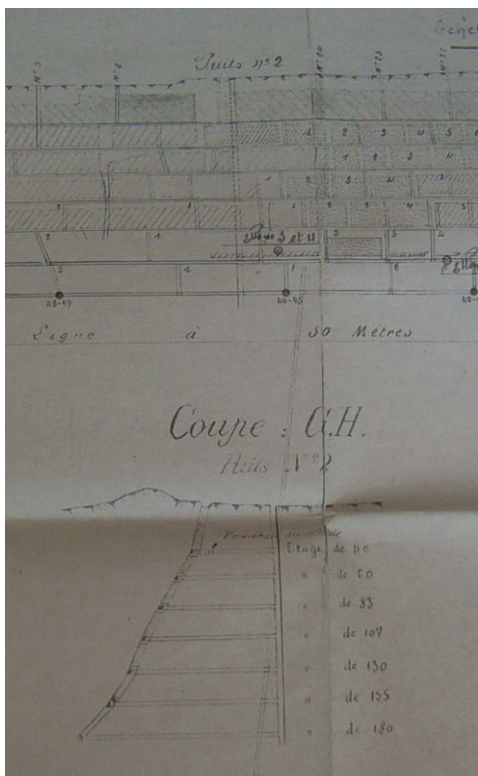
coupes du secteur du puits 2 Figures 14 : plan du secteur des cités et puits 2
